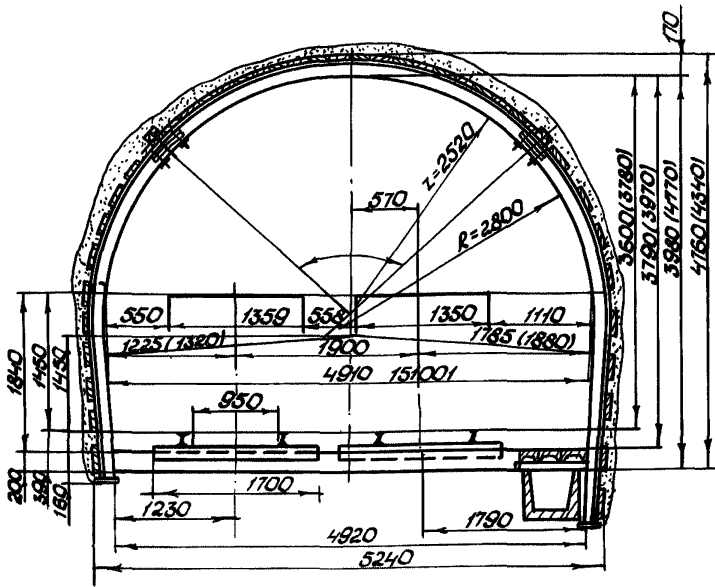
Паспорт крепления двухпутевой выработки металлической арочной крешью из спецпрофиля СВЛ-27
